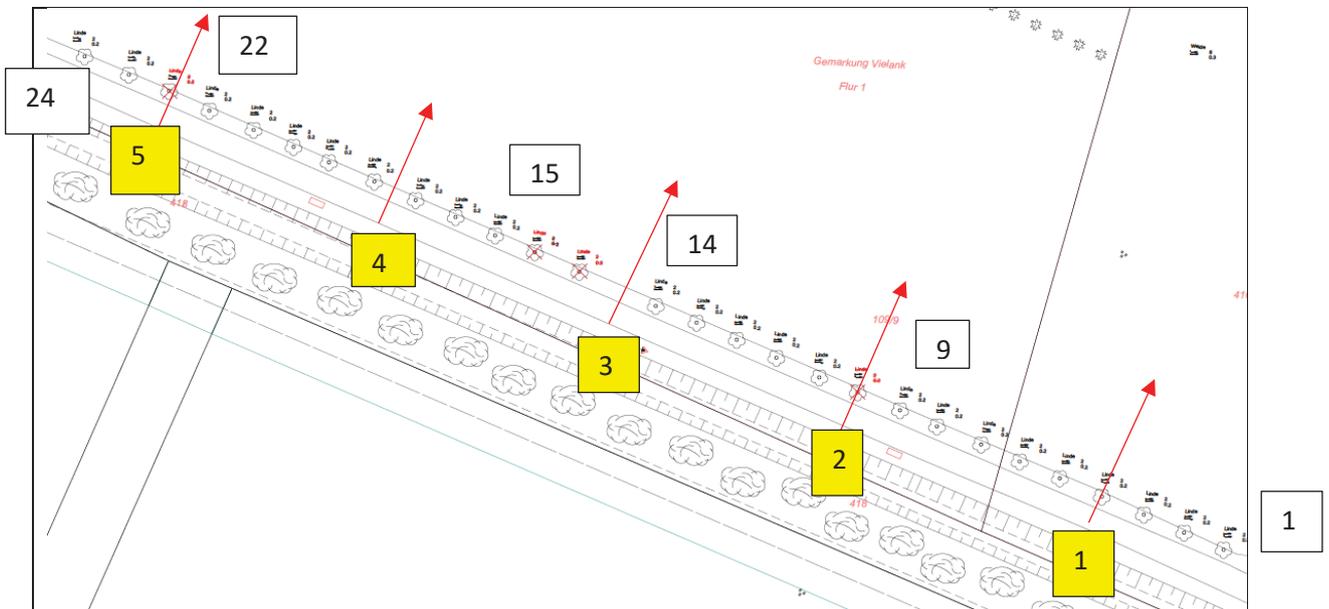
Schema der Baumstandorte und Zufahrten auf Grundlage der korrigierten Vermessung
